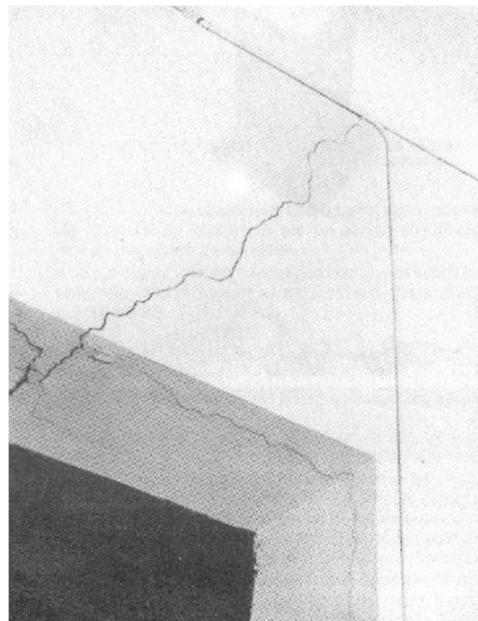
Fissura em viga causada por torção próximo ao apoio
